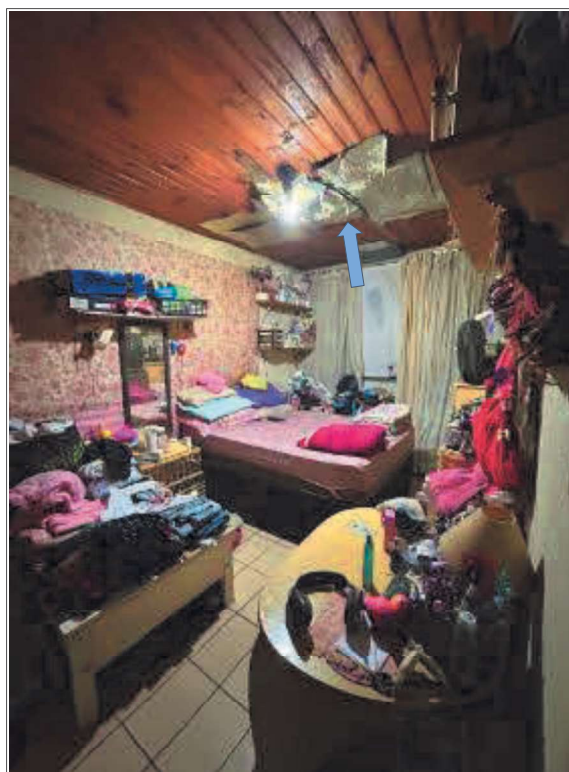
Quarto da frente - forro do teto em madeira com infiltração
